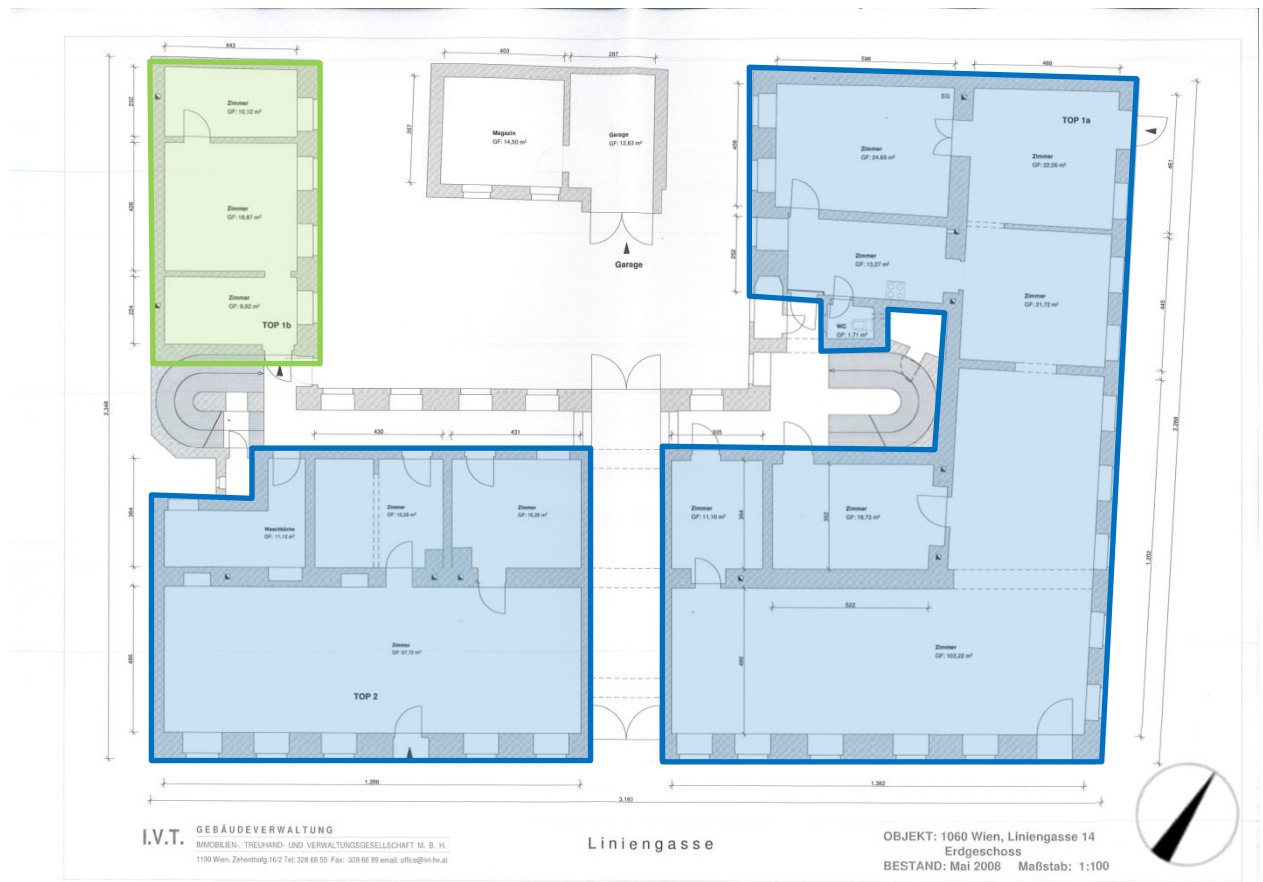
Grundriss Erdgeschoß mit Eintragung der thermischen Gebäudehülle – ohne Maßstab;
